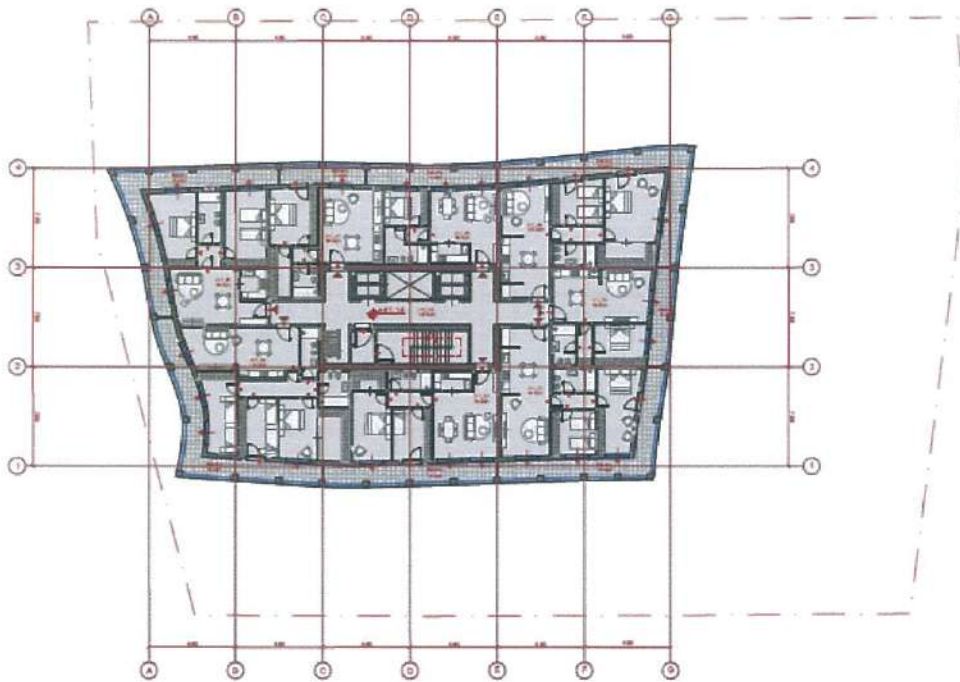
Planimetria e katit 10, në kuotën +41.14 SIP 1032 m²
